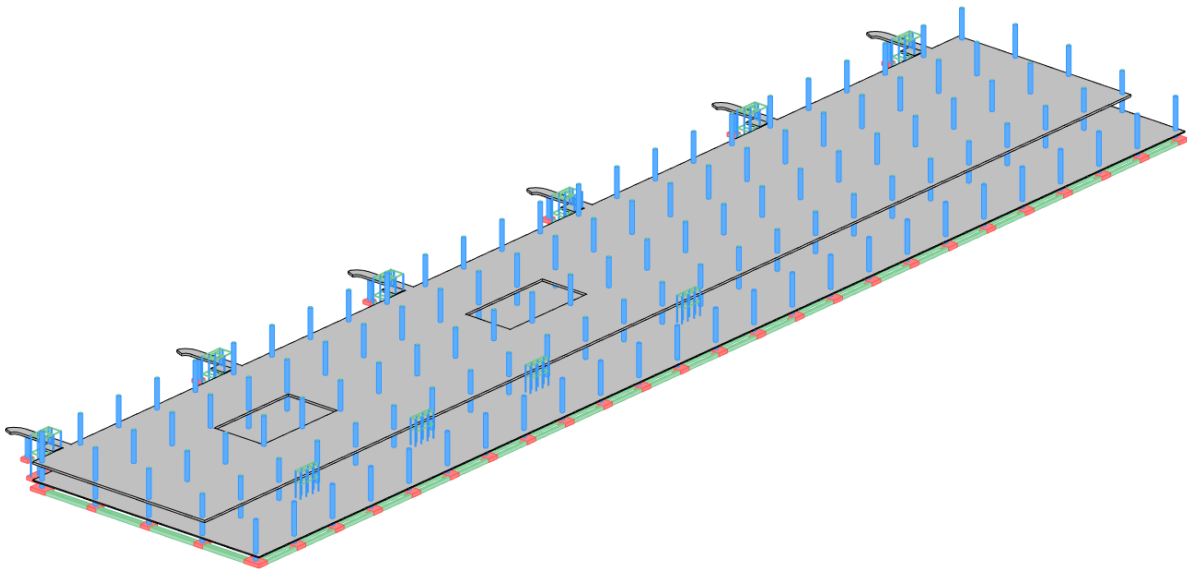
Vista 3D del forjado de la planta superior junto al resto de la estructura.
